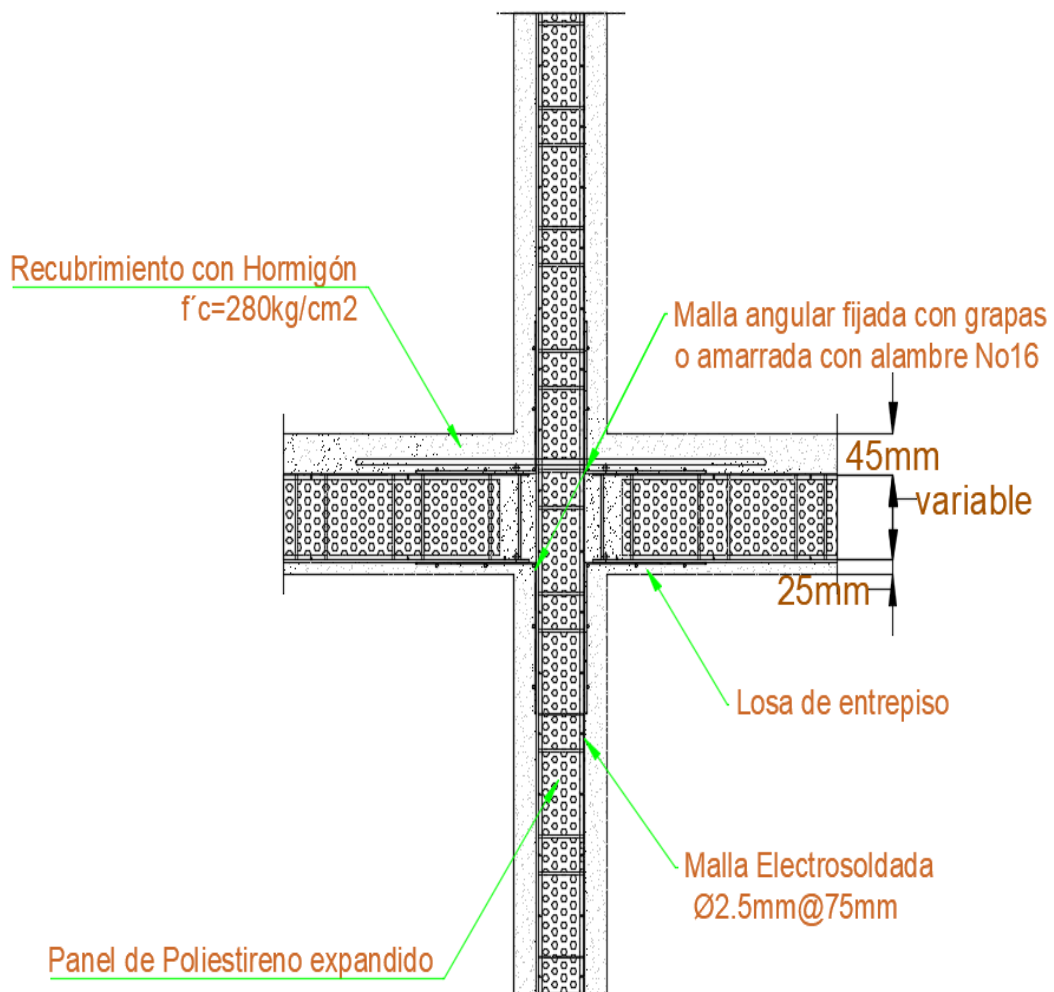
Detalle unión de paredes interior con losa de entrepiso (PLANTA)
